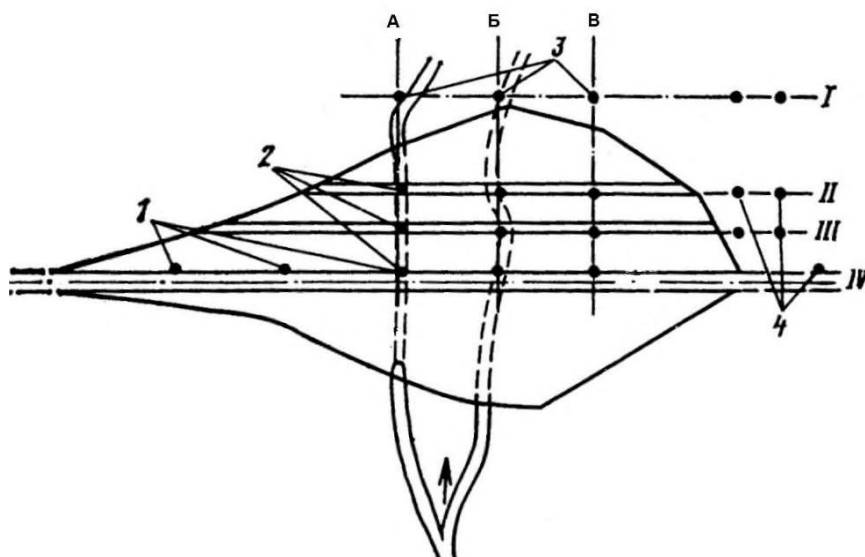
Схемы размещения марок и створных знаков на грунтовой плотине [17]: 1 и 2 – для определения продольной и поперечной осадки; 3 – для фиксирования появления выпора; 4 – створные знаки; 1...IV – продольные створы; А, Б, В – поперечные створы
